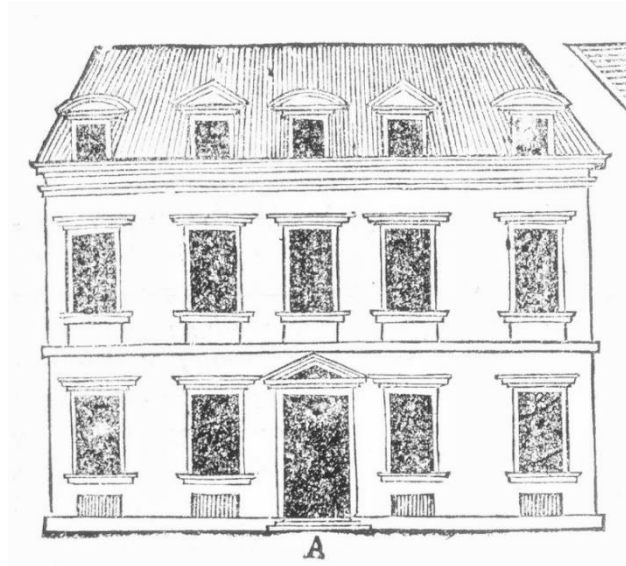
Inigo Jones: *Maltravers House*, Entwurf Hauptfassade, London, 1638
